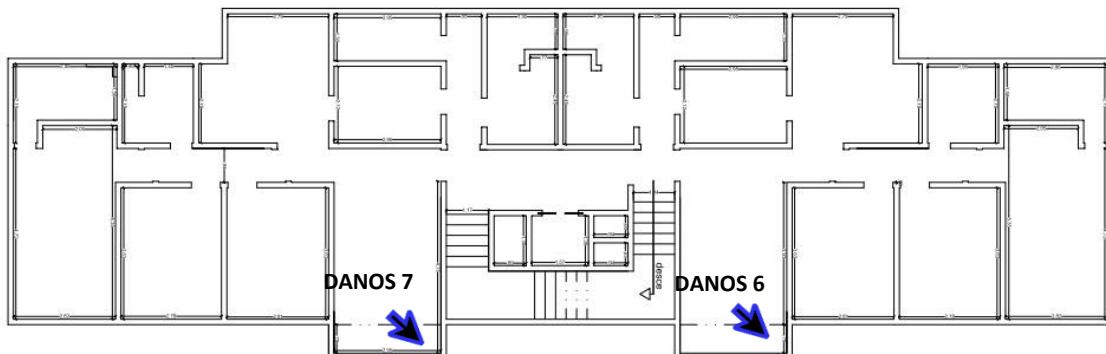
Planta Baixa (croqui) do Pavimento do 2º andar – Bloco C – Cond. Armando Lôbo.
